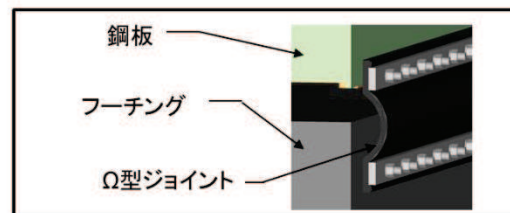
鋼製遮水壁（鋼板）の平面配置図
